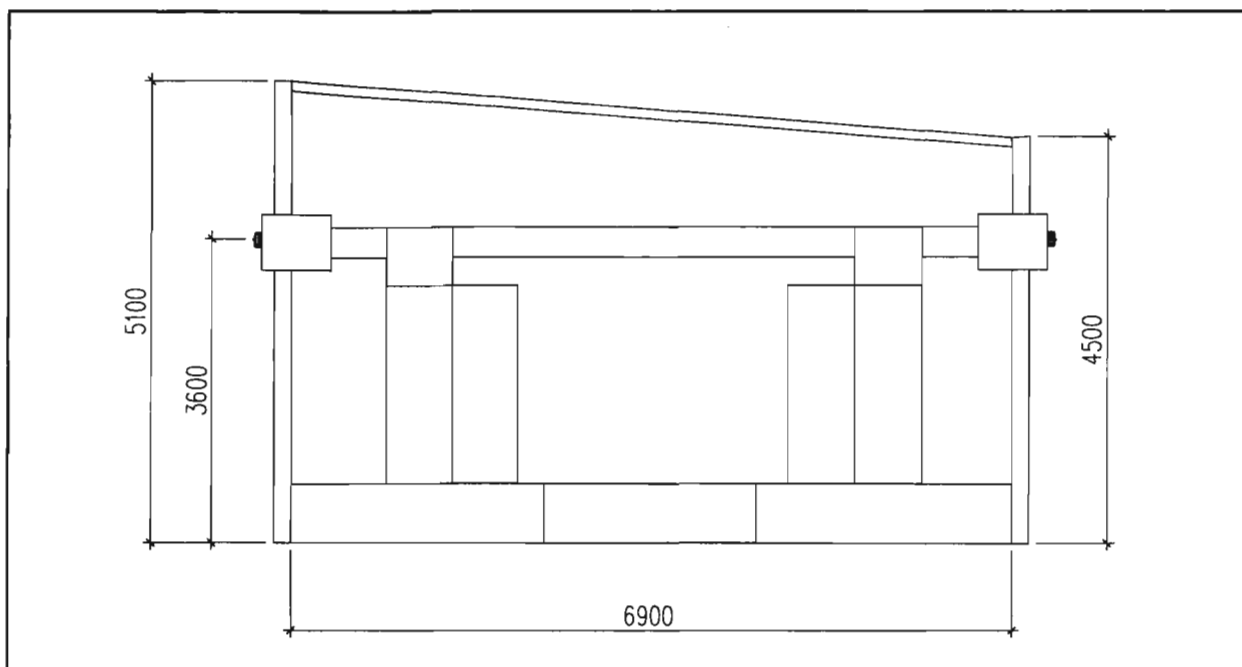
Поперечный разрез КРУ в БМЗ
